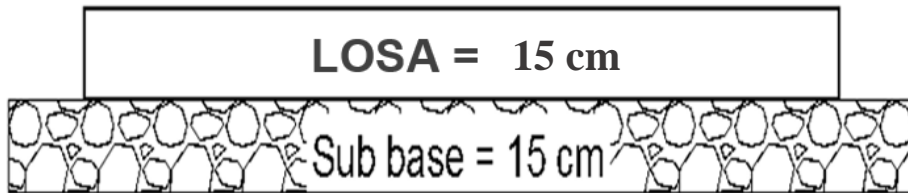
Diseño de los espesores del Pavimento Rígido E – 2.
